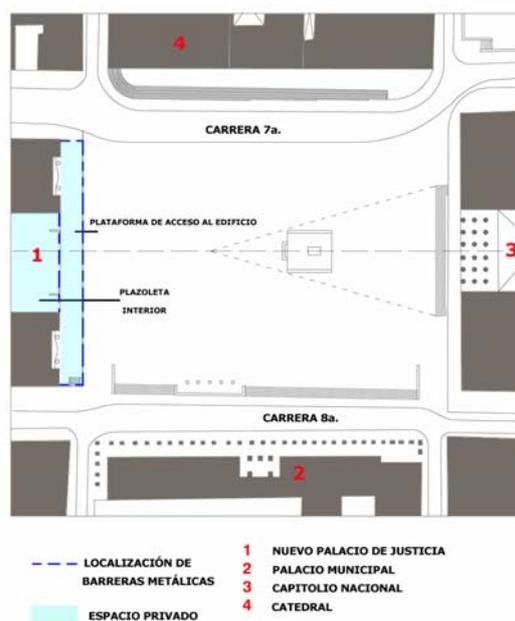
(Derecha) Planta de localización del edificio (autor).
